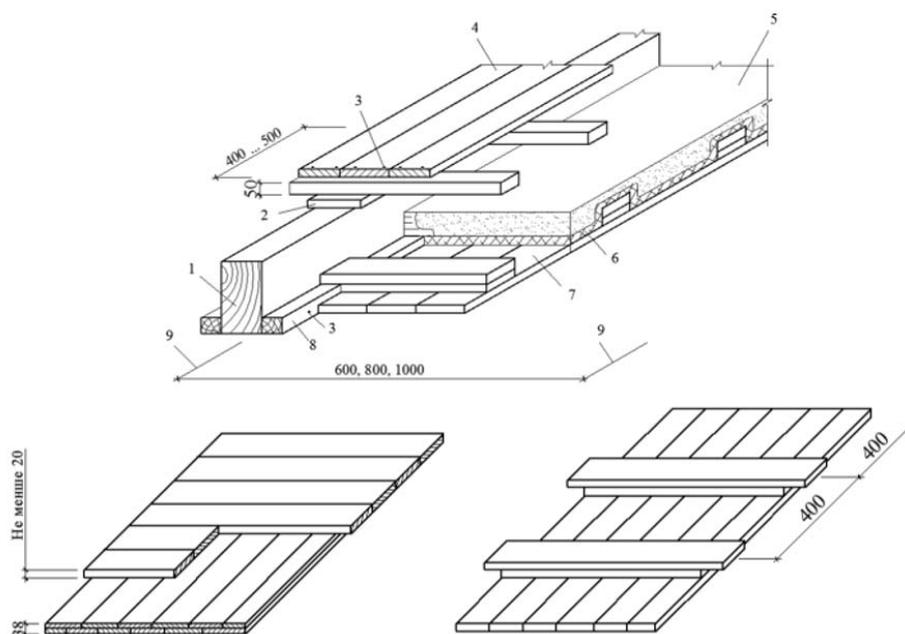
Конструктивна схема перекриття по дерев'яних балках:
